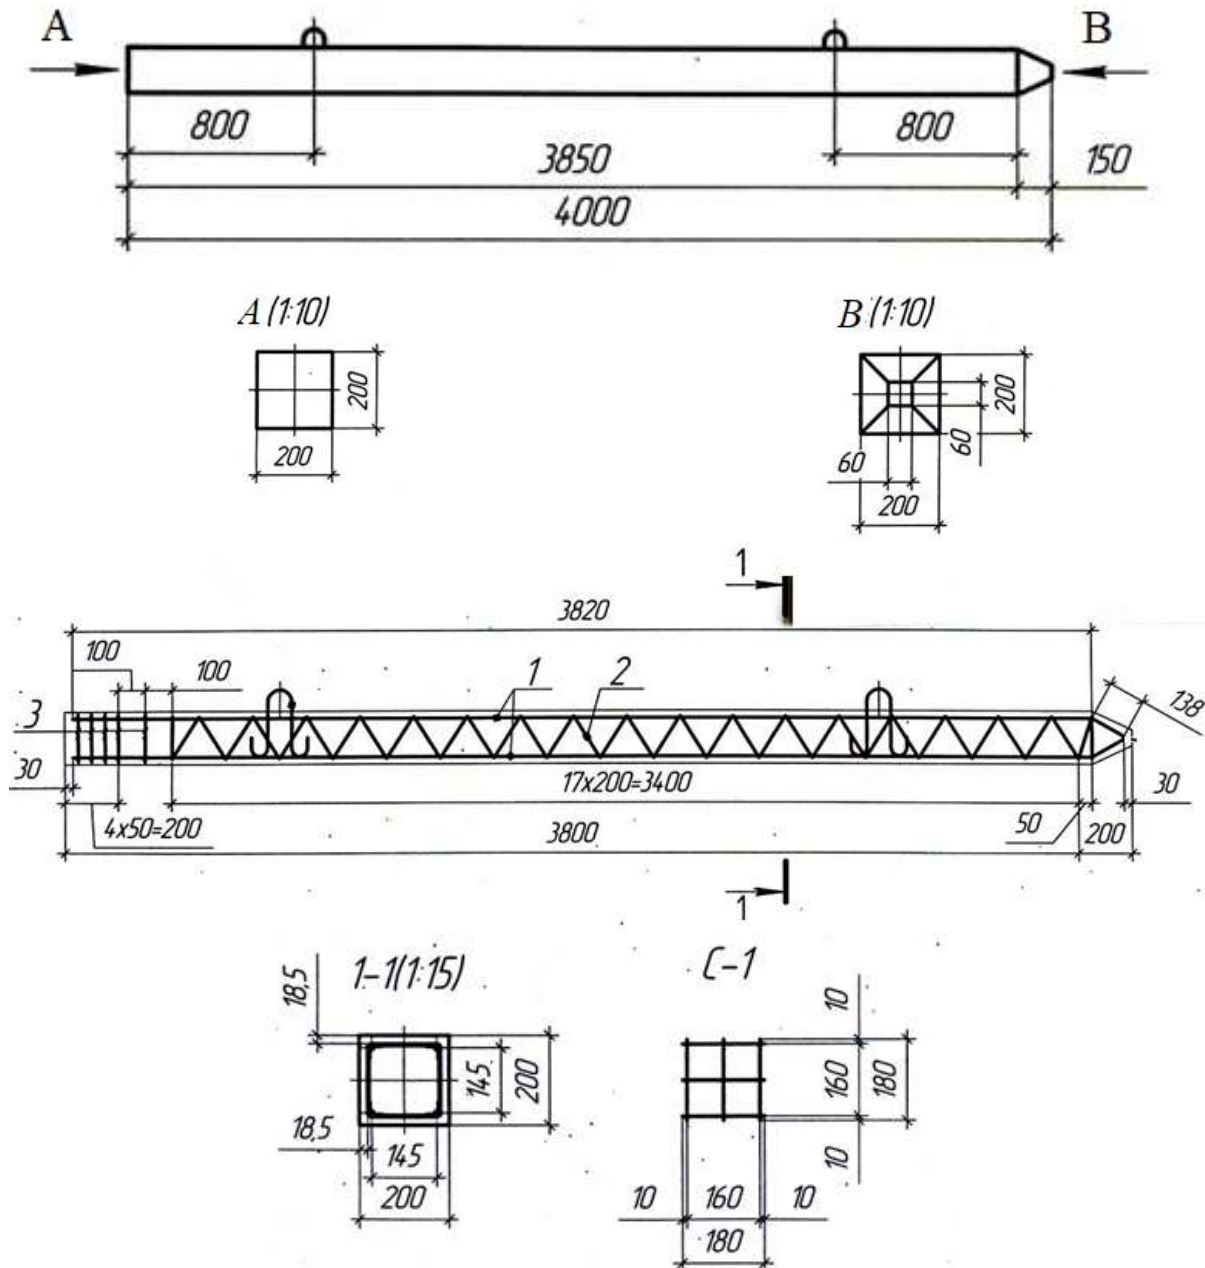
Геометрические размеры и арматурный чертеж типовой бетонной сваи
